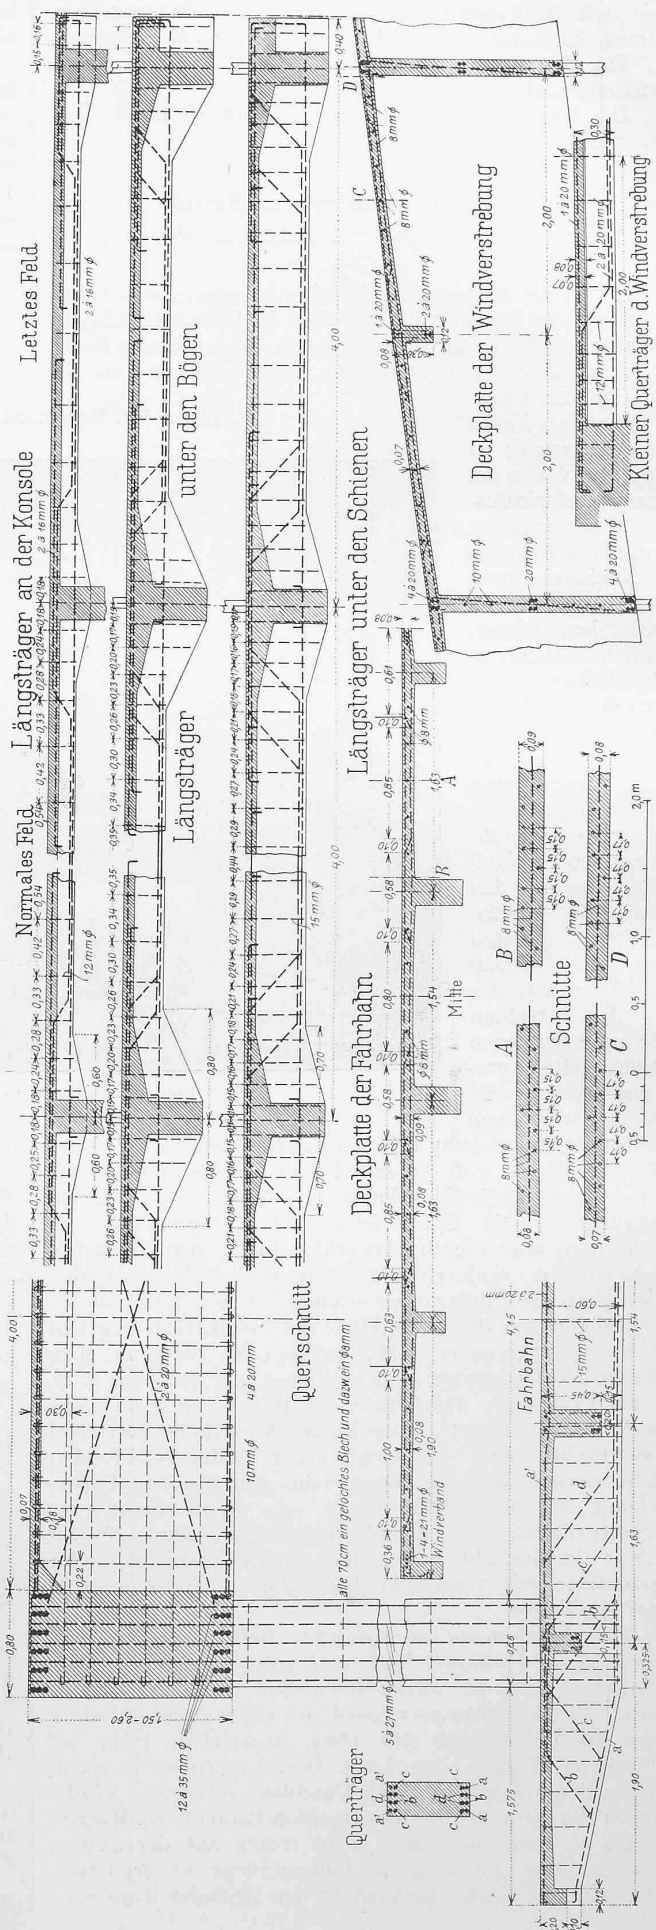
Schnitte und Details der Armierung der Brücke bei Chippis. — Masstab 1 : 50.
